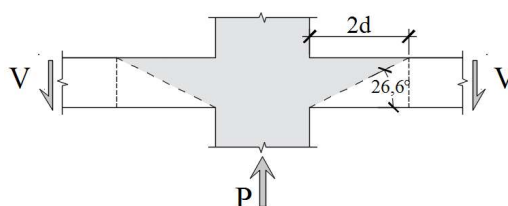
Punção em ligação laje-pilar segundo a NBR 6118 (2014)
